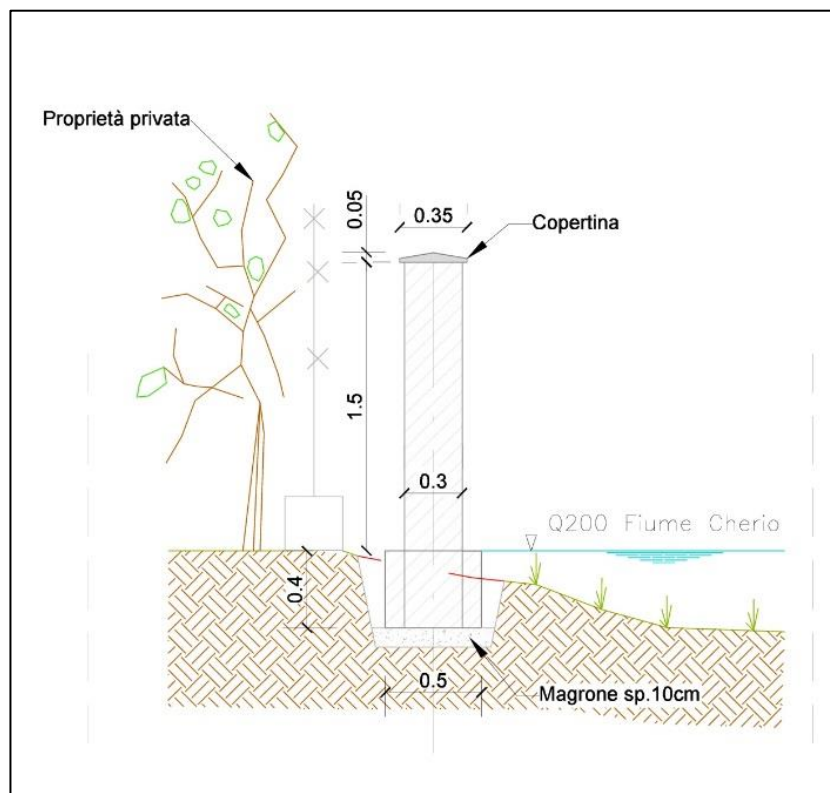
Sezioni tipo intervento muro di contenimento in c.a. – sponda destra
